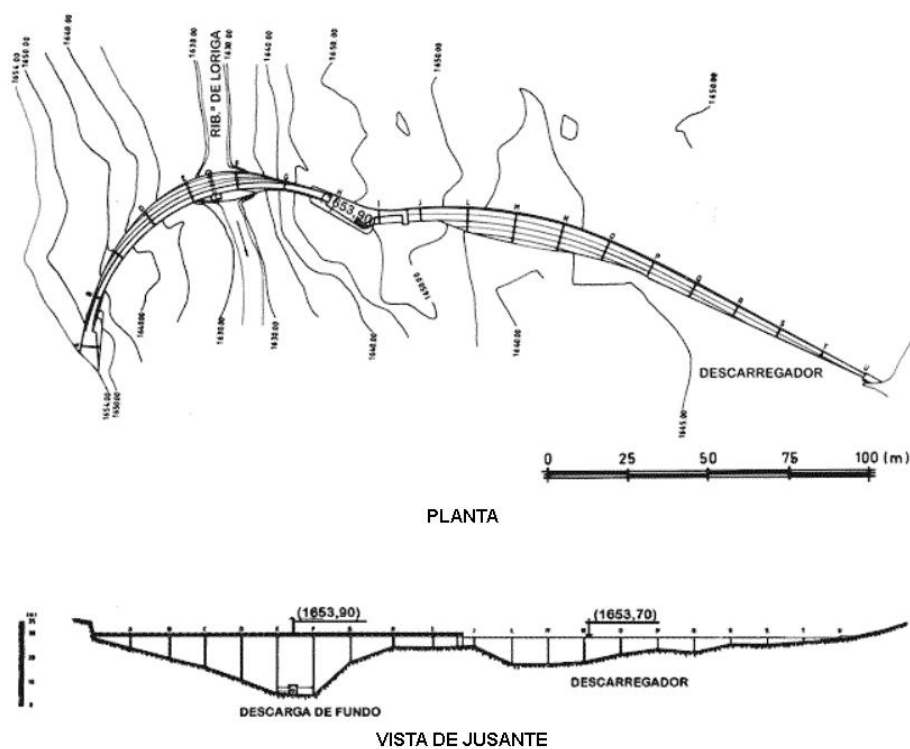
Barragem do Covão do Meio em planta e vista de jusante (CNPGB, 2019)
